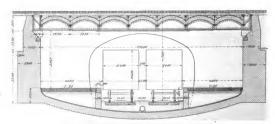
Querschnitt einer Station mit gerader Decke, 1:150,
